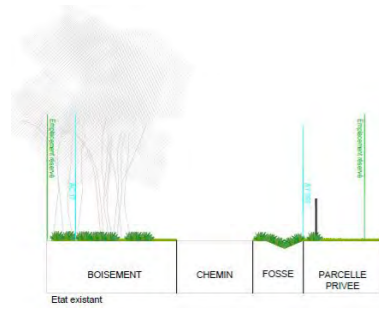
Profil en travers de l'existant – Coupe CC' (bis)
